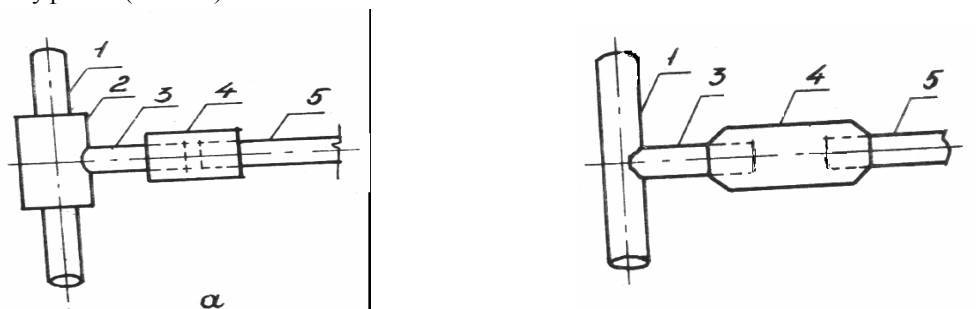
Схемы присоединения ответвления к газопроводу: а – сварным тройником; б – муфтой; 1 – газопровод; 2 – сварной тройник; 3 – штуцер; 4 – муфта; 5 – ответвление
